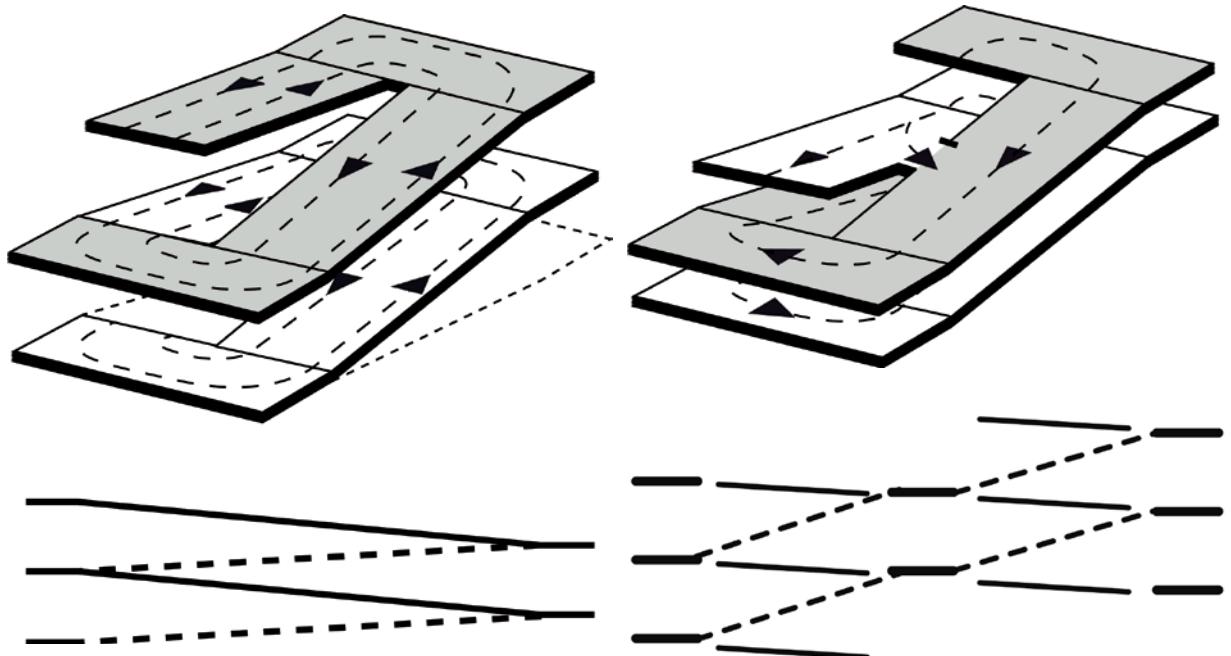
Vollrampenanlage (Neigung der Parkrampen $\leq 6\%$, horizontale Flächen zur Zu- und Abfahrt) [32]
